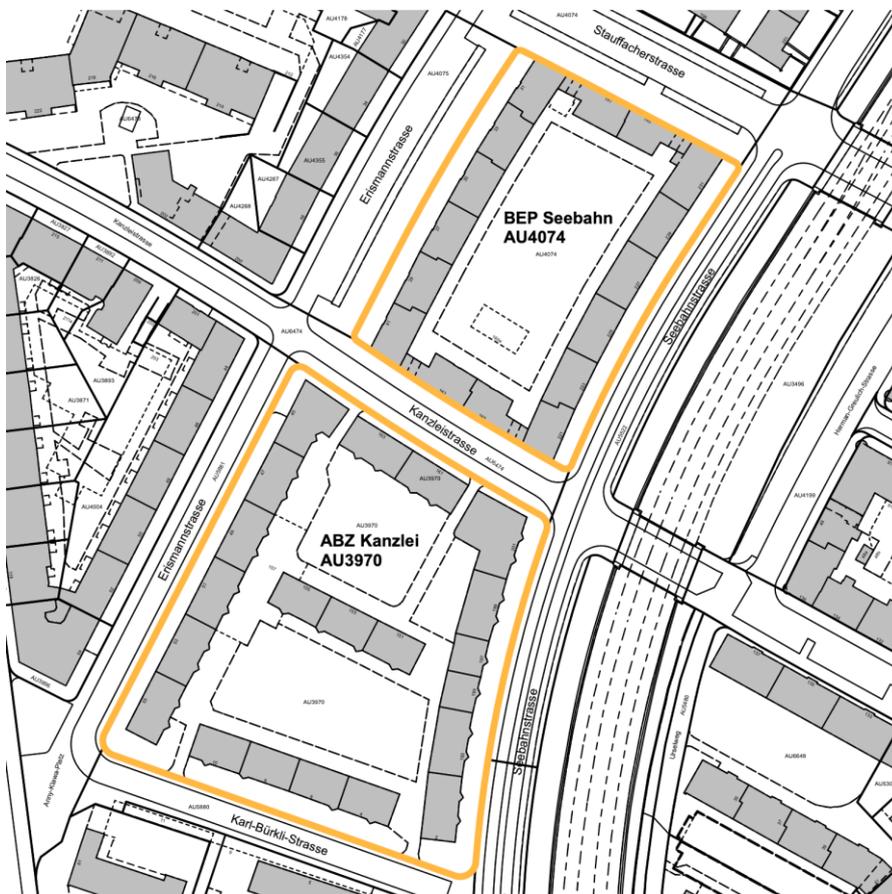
Bestehende Bauten, mit Perimeter Gestaltungsplan
